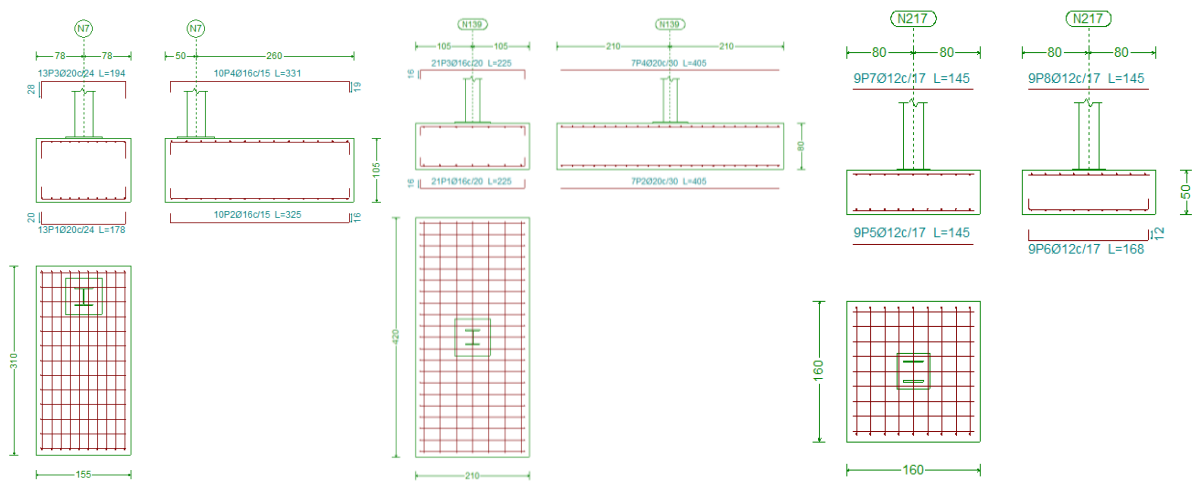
Cimentaciones tipo de los laterales de los pórticos, pilares centrales o de pórticos de fachada, y de zapatas de esquina o pilares interiores de forjado, respectivamente.
